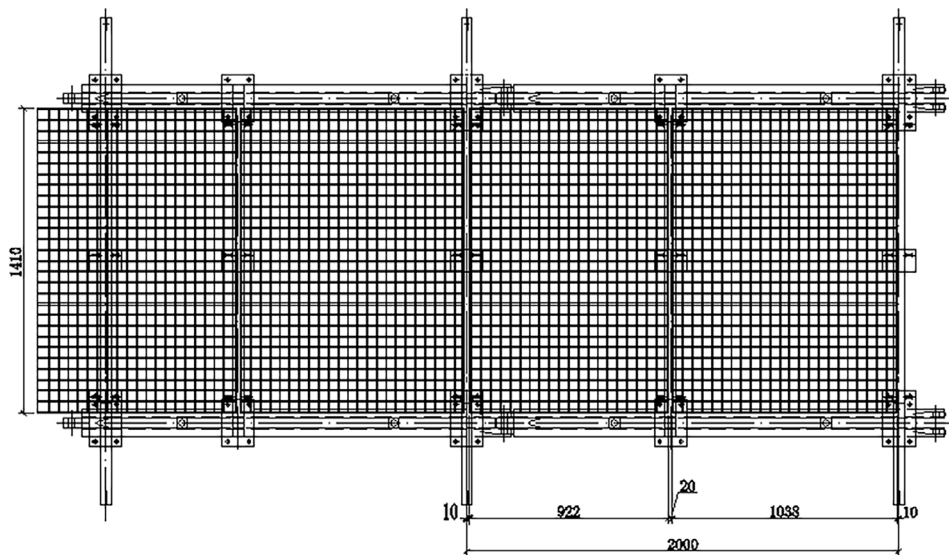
横梁与格栅板架设后平面图(第一节与第二节)(单位:mm)
